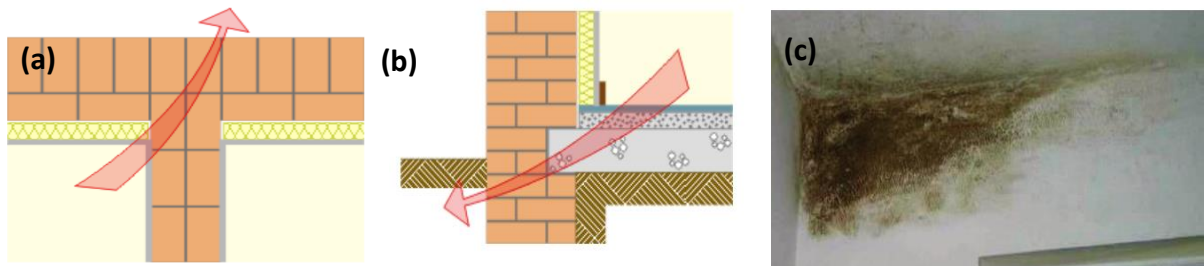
(a) Liaison avec un mur intérieur (coupe horizontale), (b) Fondation (coupe verticale), (c) Exemple de moisissures liées à un pont thermique) [44]
